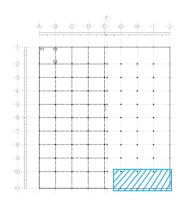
Ubicación de las cisternas en el plano. Fuente: Elaboración propia.
